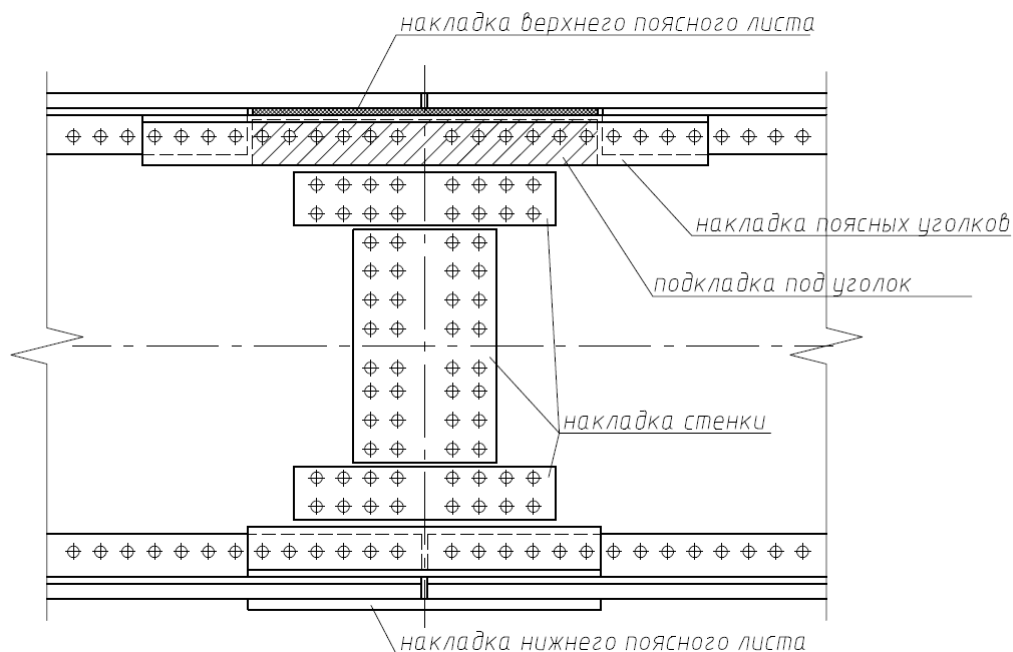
Монтажный стык большепролетной подкрановой балки с ДПС
